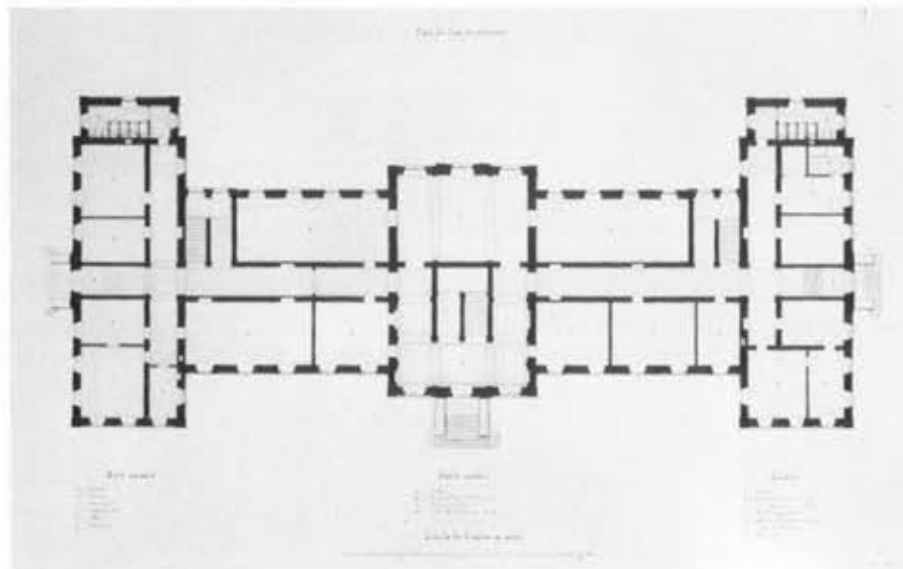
Joseph de Kalbermatten, 1890: plan du rez-de-chaussée. Archives de Kalbermatten architectes, déposées aux Archives Cantonales du Valais, B 75.
